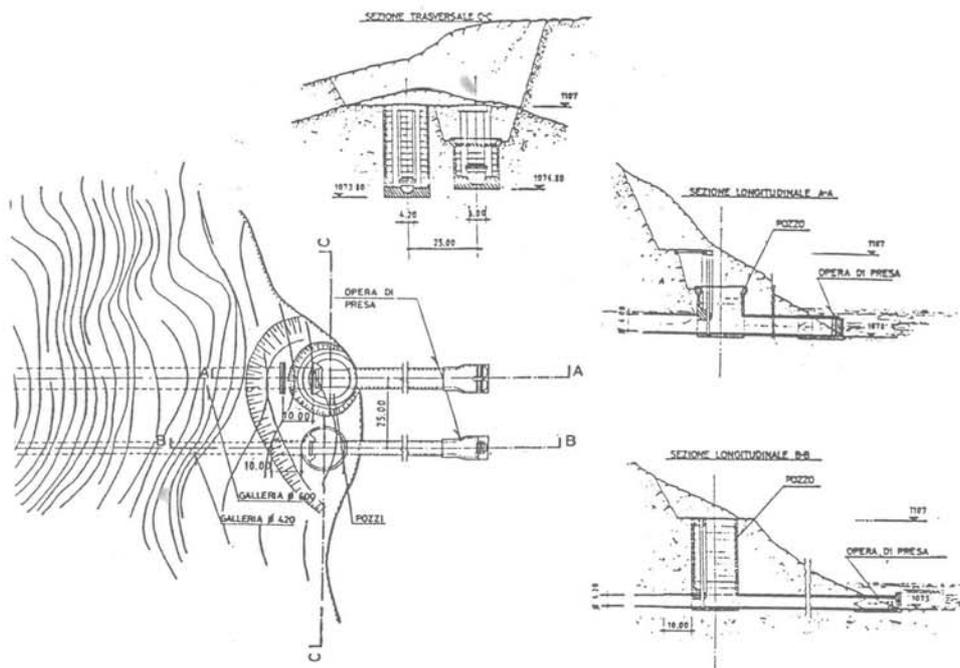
Planimetria e sezioni dell'imbocco di monte
